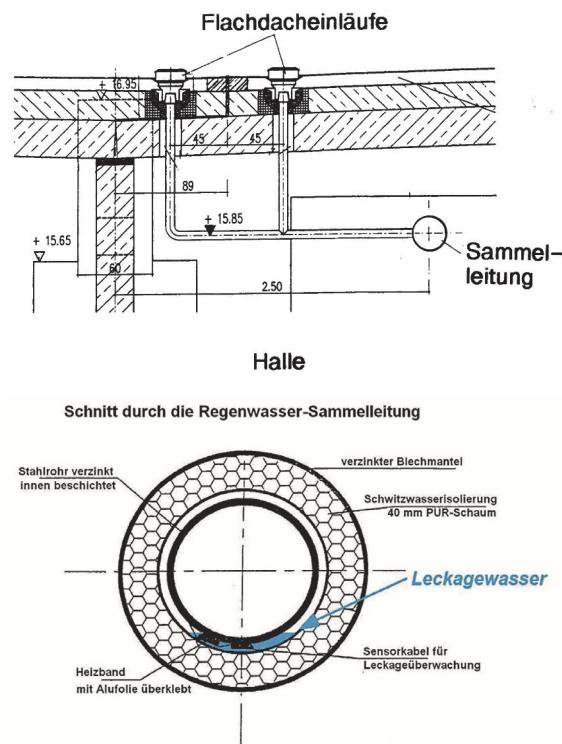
Detail Dachabläufe und Schnitt durch die Regenwasser-Sammelleitung
